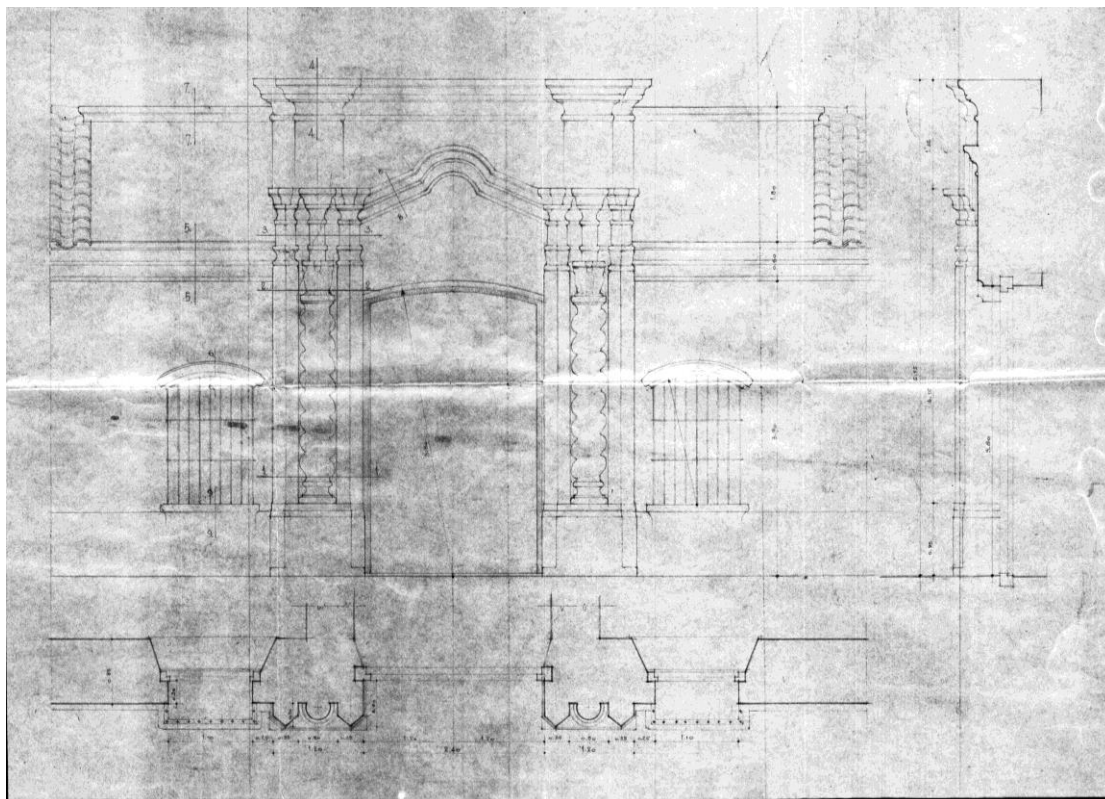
Proyecto, Diseño de la fachada, escala 1:20, Plano N° 61, 1941 DNOA
